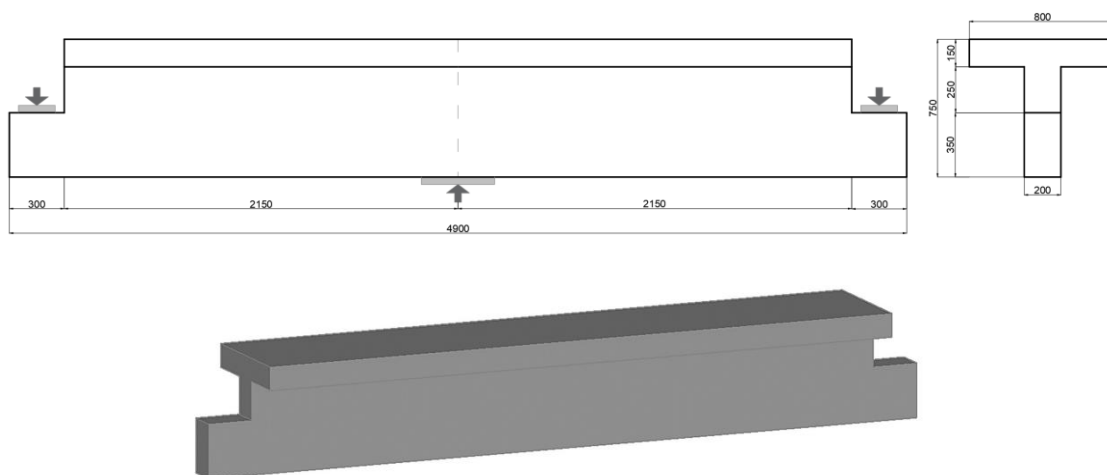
Geometria delle travi. Dimensioni in mm. (a) Vista longitudinale. (b) Sezione trasversale. (c) Vista 3D [2]
